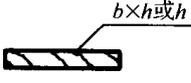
非焊接节点板尺寸的标注方法
